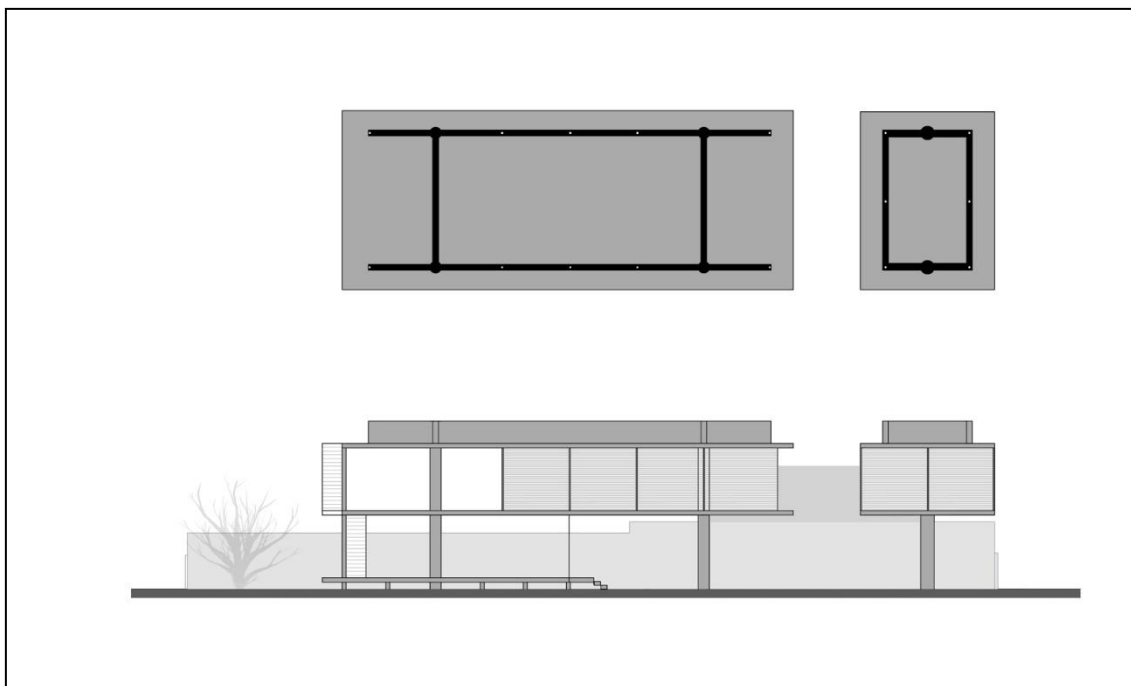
Elevação e cobertura, sem destaque nos elementos estruturais, de ideia parcialmente descartada em fase intermediária do trabalho. Fonte: AUTOR (2017).
